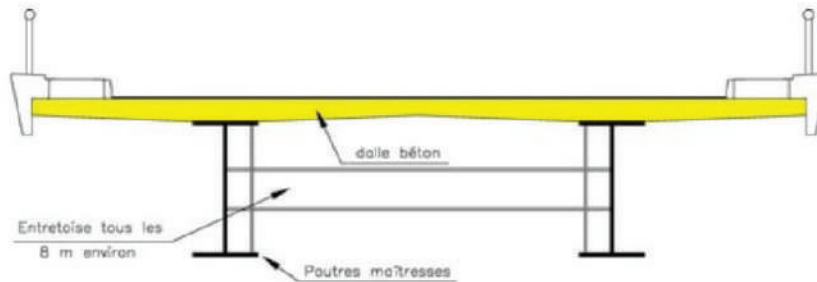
Morphologie général d'un pont bipoutre à entretoise.
